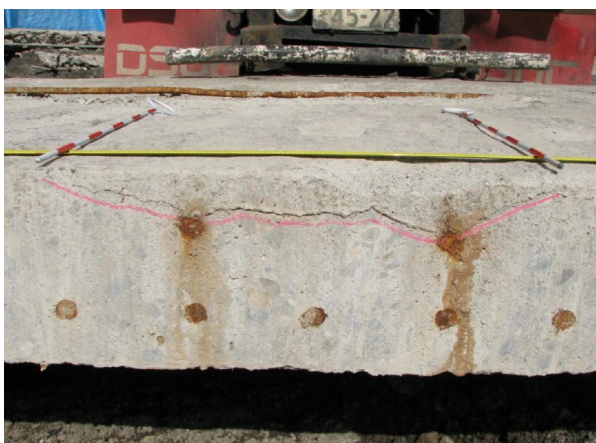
上縁鉄筋に沿った水平ひび割れ
